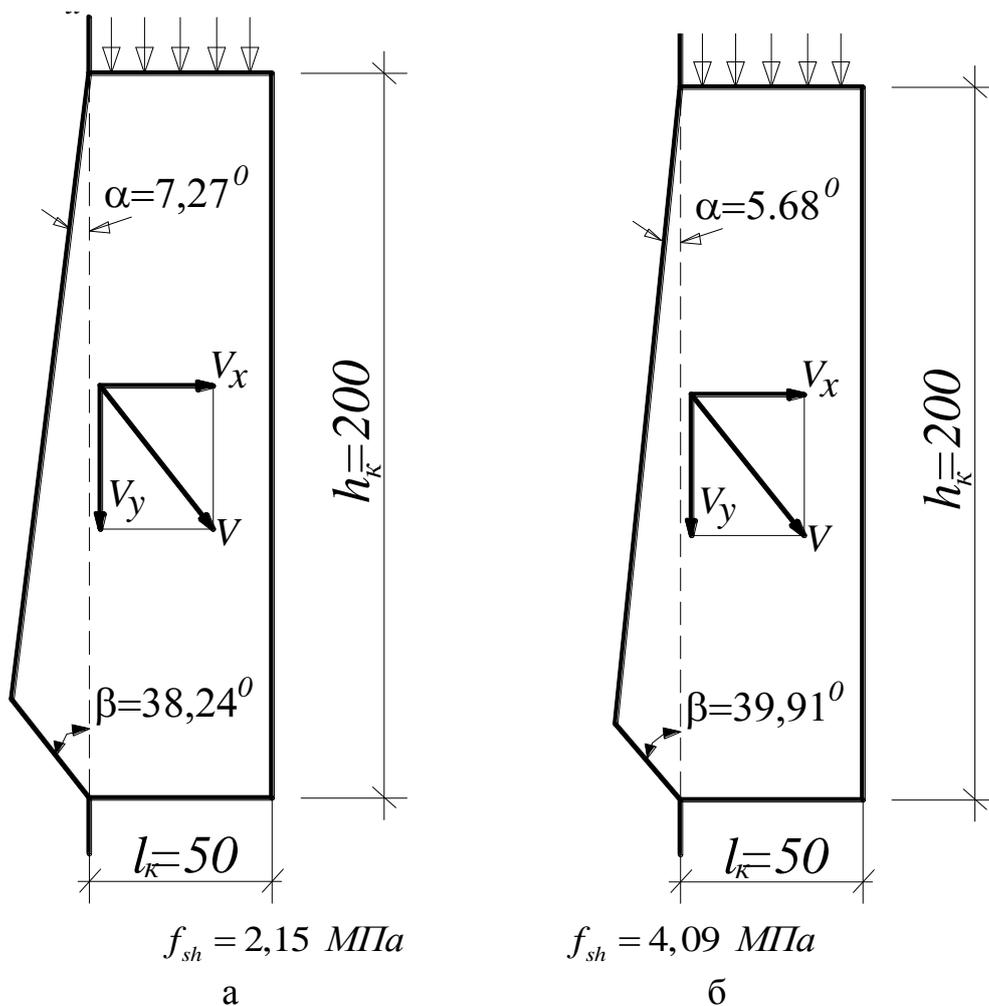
Параметри кінематичної схеми руйнування бетонної шпонки для бетону класу: а – С16/20; б – С40/50
